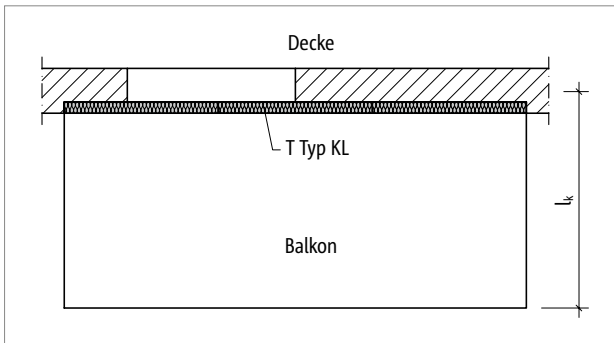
Schöck Isokorb® T Typ KL: Balkon frei auskragend
